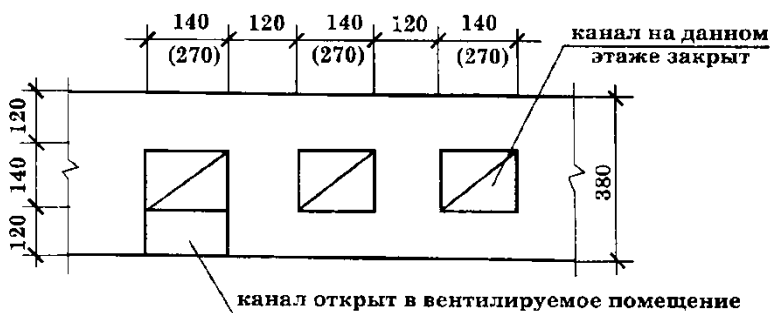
Размещение вентиляционных каналов во внутренних стенах
